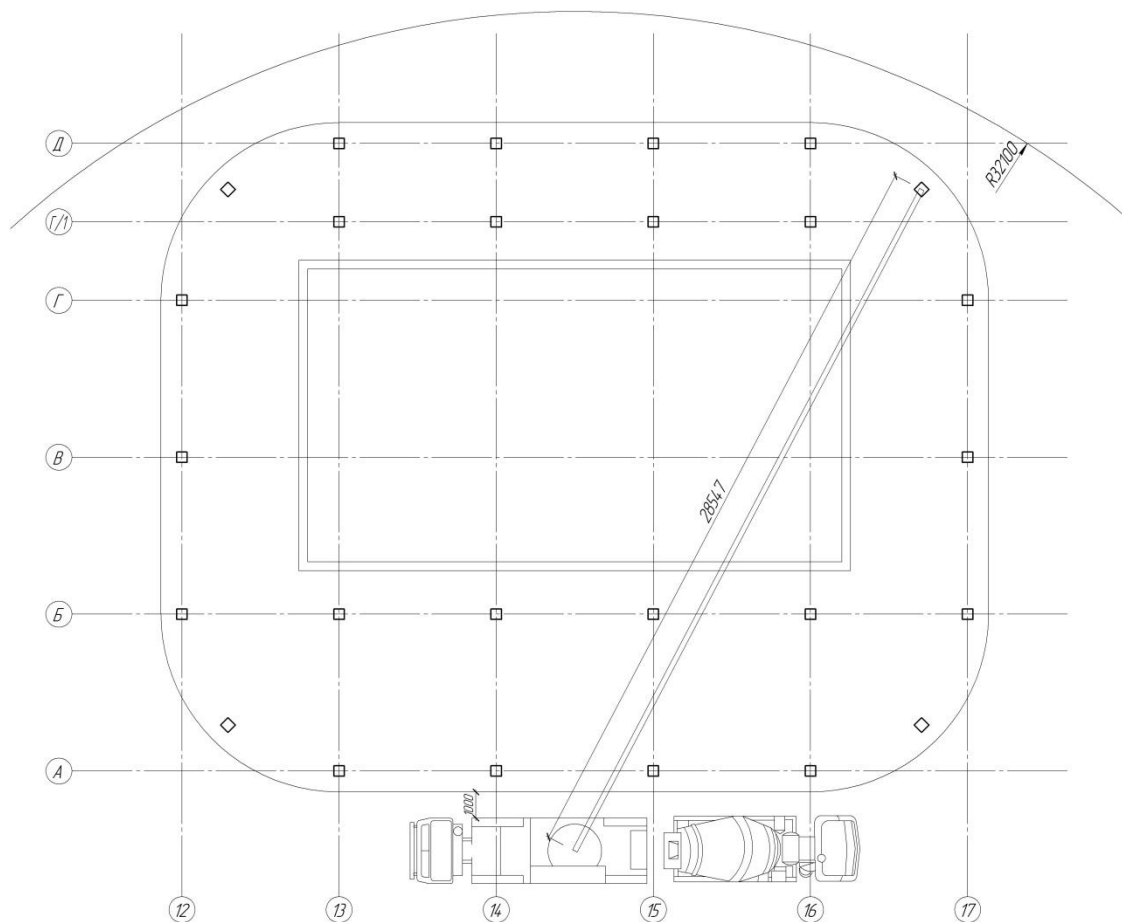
Схема для определения требуемой дальности подачи бетонной смеси
